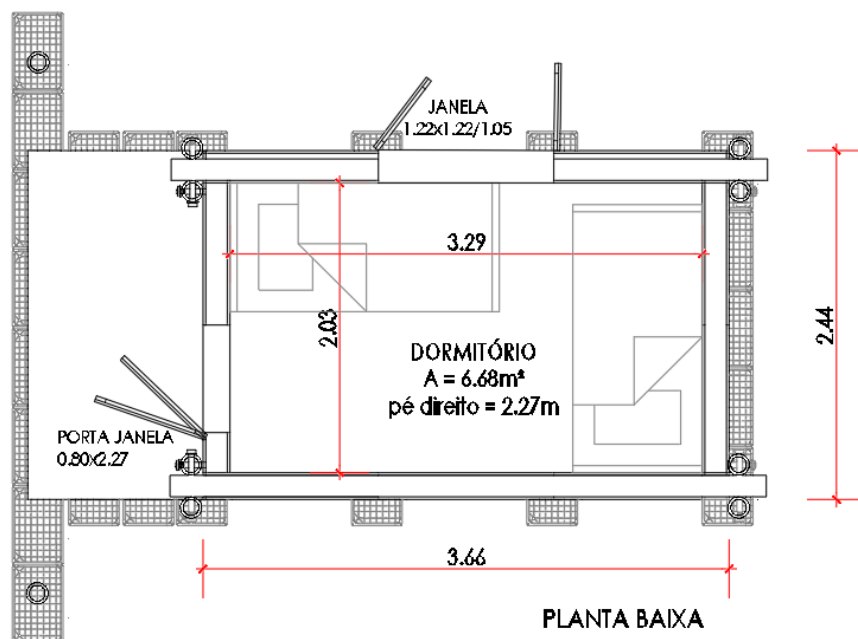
Planta baixa do abrigo. Fonte: Autores (2023).
